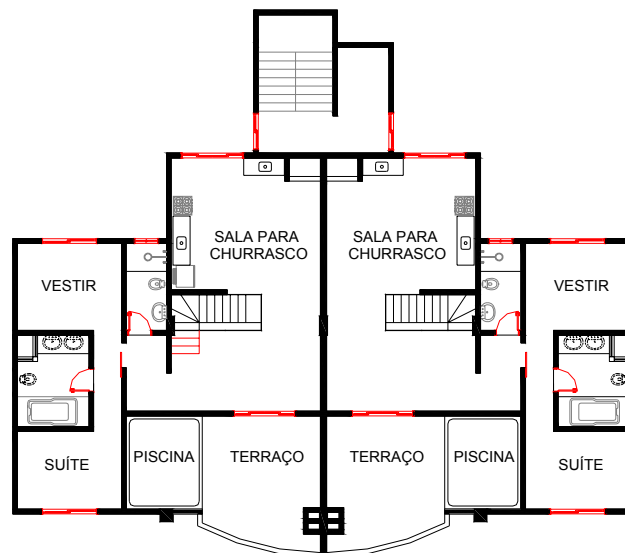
Planta Baixa do pavimento de cobertura do Estudo de caso D.
